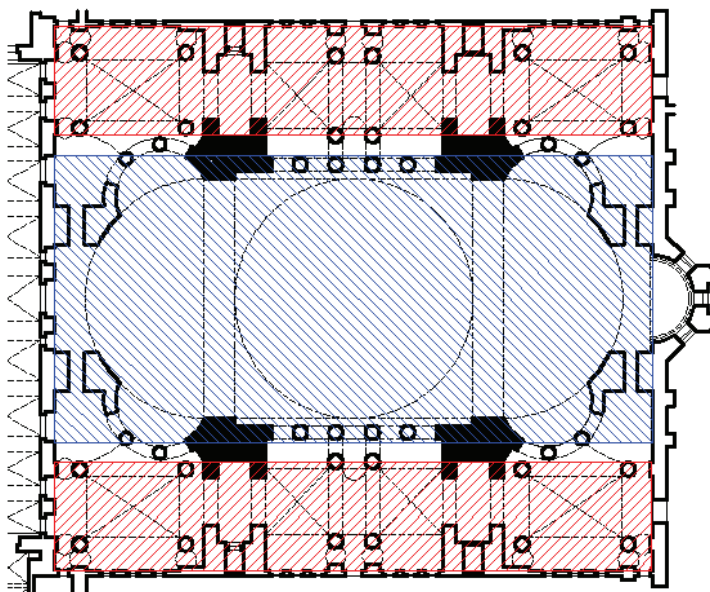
Esquema en planta de las naves de Santa Sofía. (Dibujo del autor).
